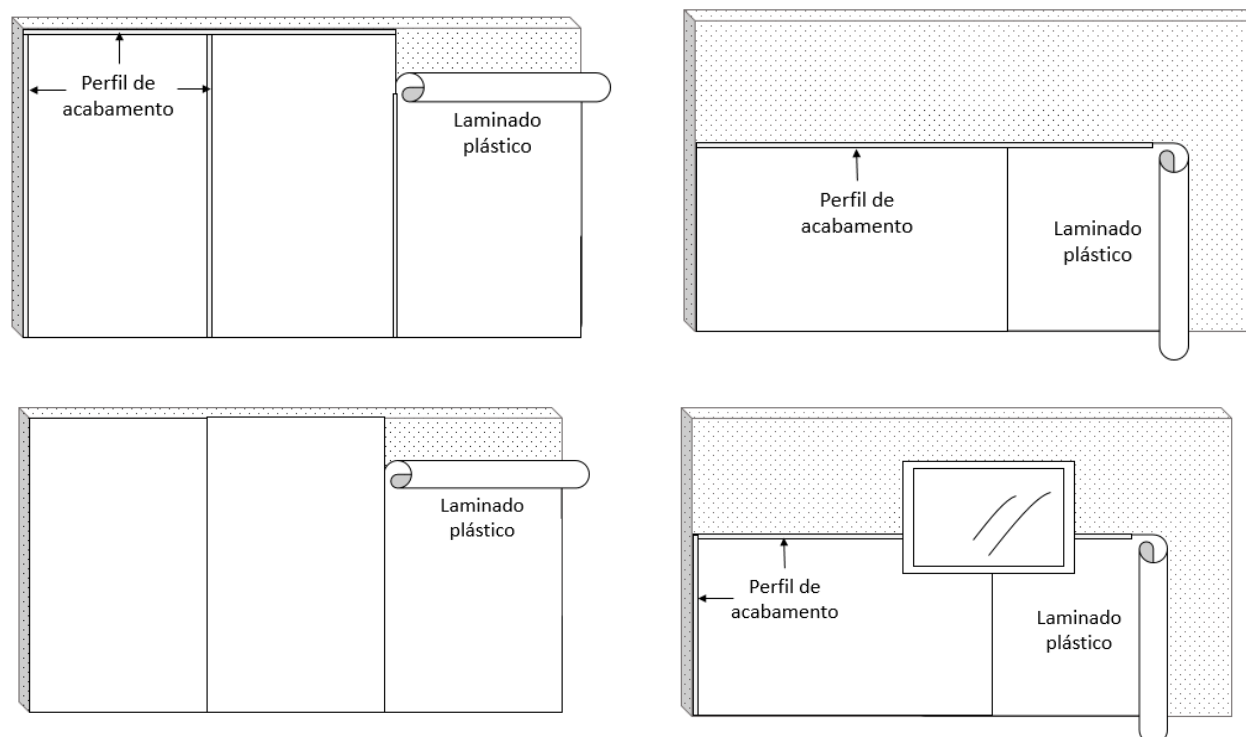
Exemplos de configurações do sistema de revestimento laminado plástico
